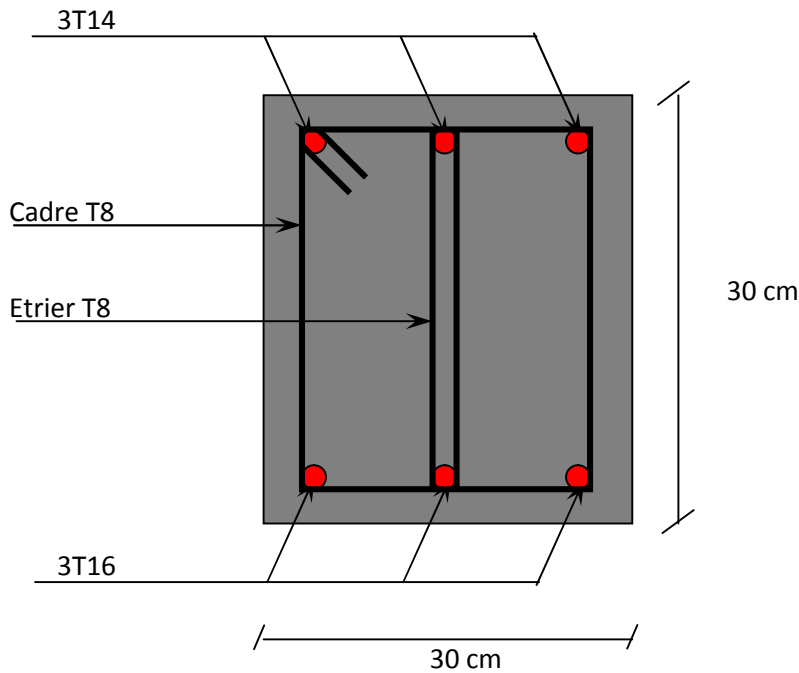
Schéma de ferrailage de la poutre de chaînage
